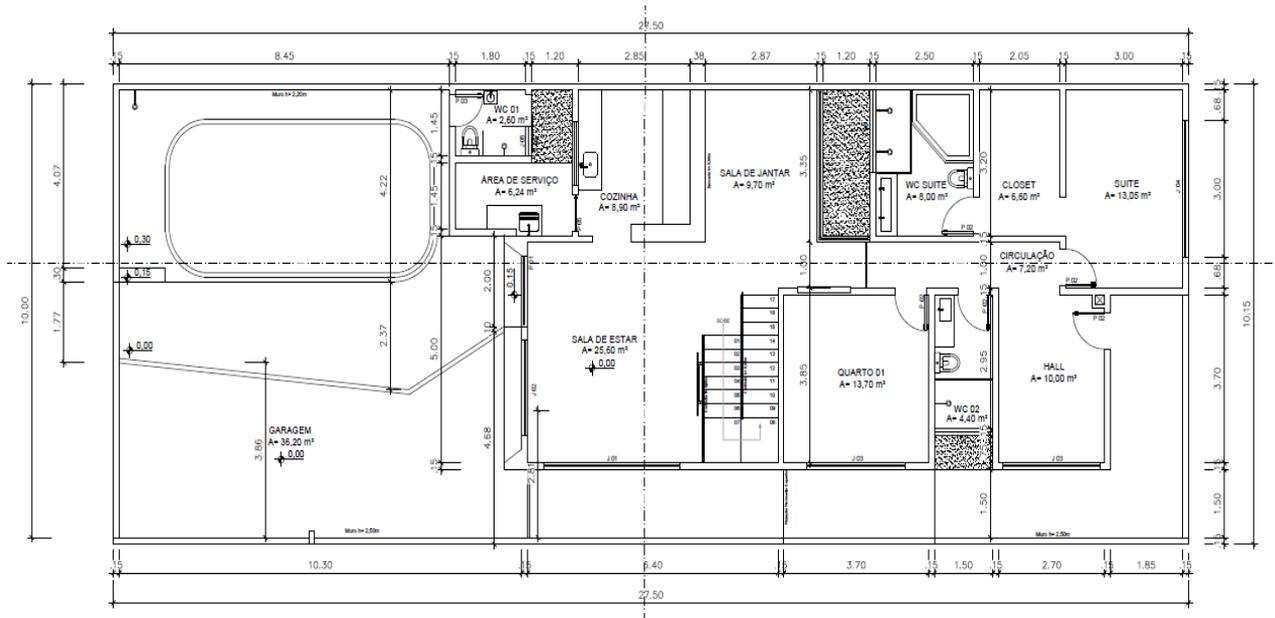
Planta baixa do térreo (ADAPTADO DO PROJETO ORIGINAL, 2018).
